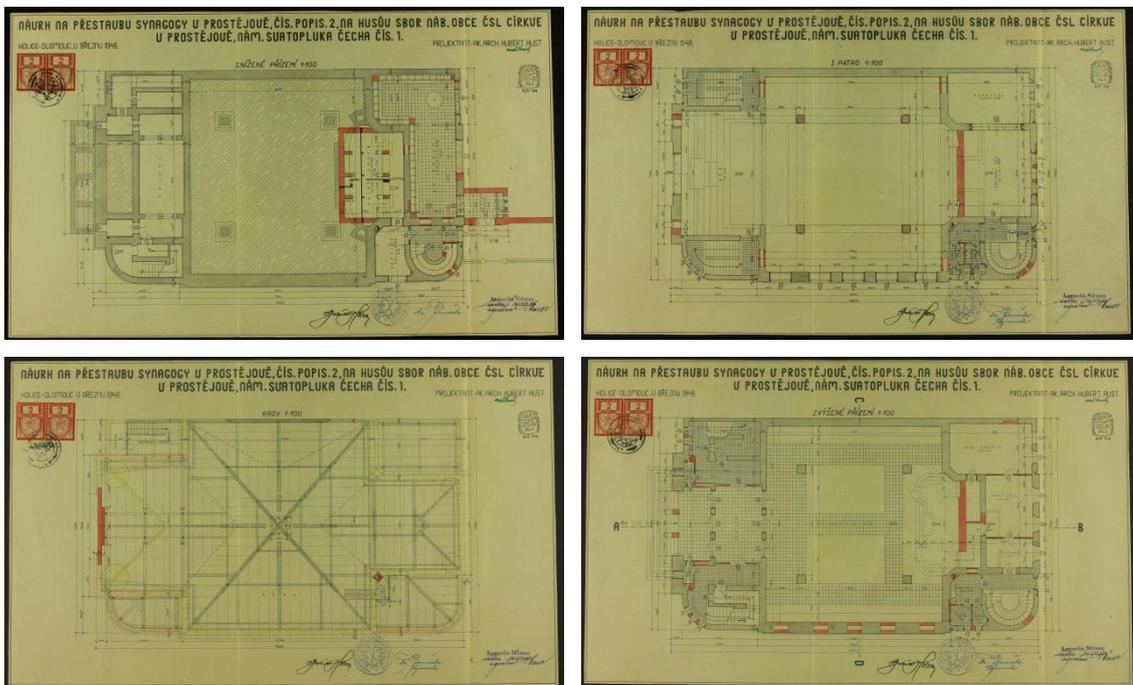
Grundrisse Umbau Hussitische Kirche
